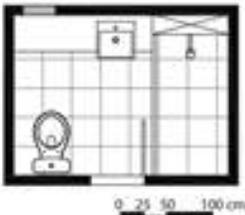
Sugestão "A" de planta baixa do banheiro nº 3.
